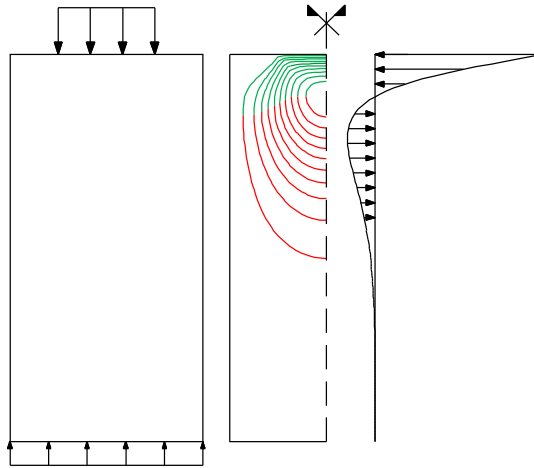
Distribuição de forças horizontais na secção do eixo de simetria da parede.
